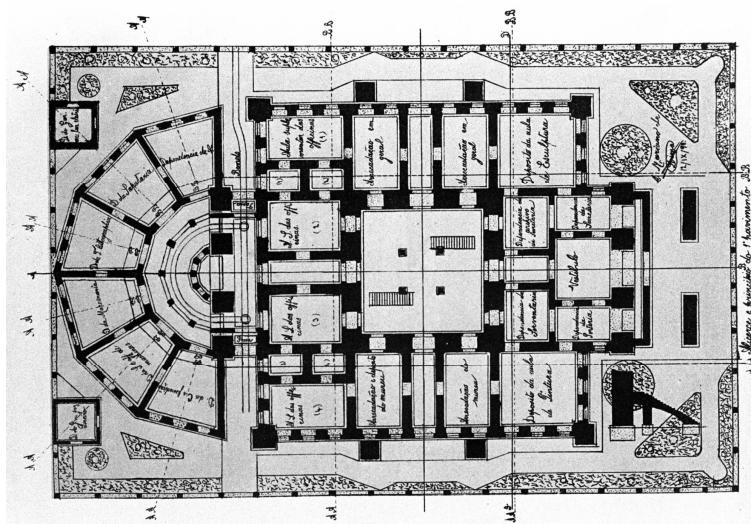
Projeto para a Escola de Artes: planta-baixa do 1º pavimento.
